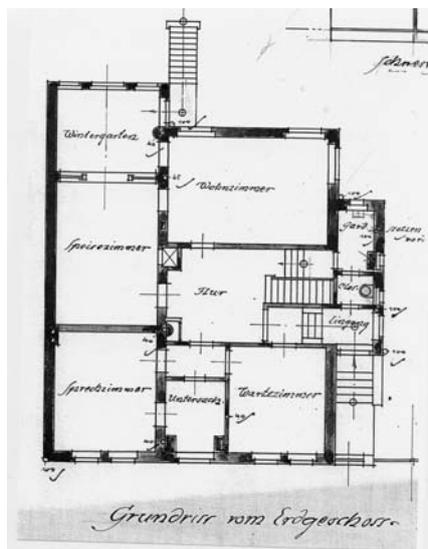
, H. Plange, Haus Clarfeld, Grundriss Erdgeschoss, 1914
